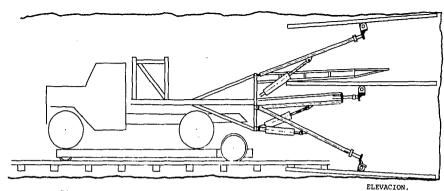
c. Jumbo especial montado sobre camión en posición listo para barrenar.
